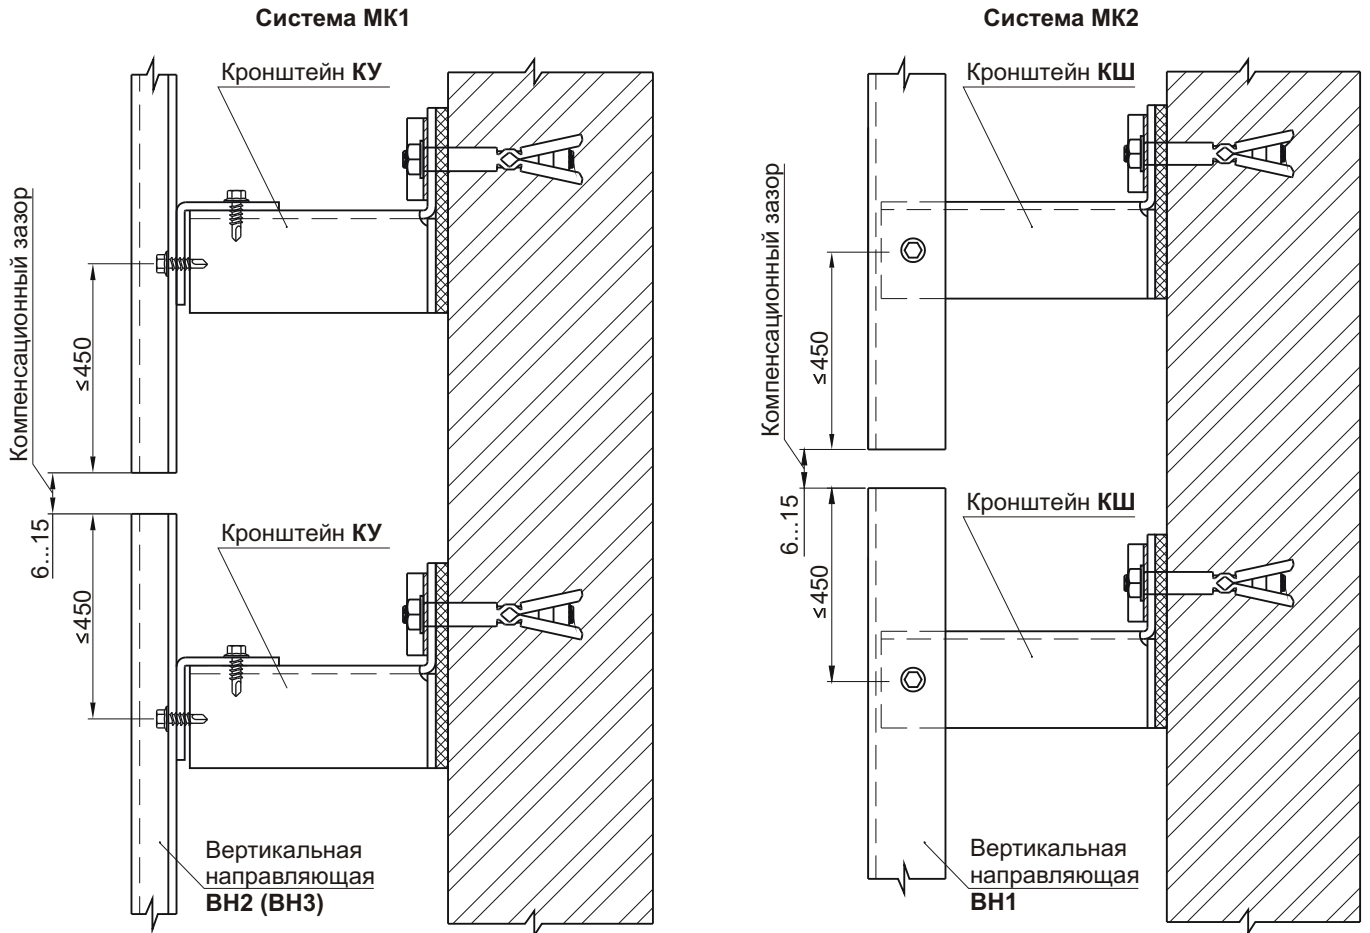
Проектный компенсационный зазор между вертикальными направляющими
